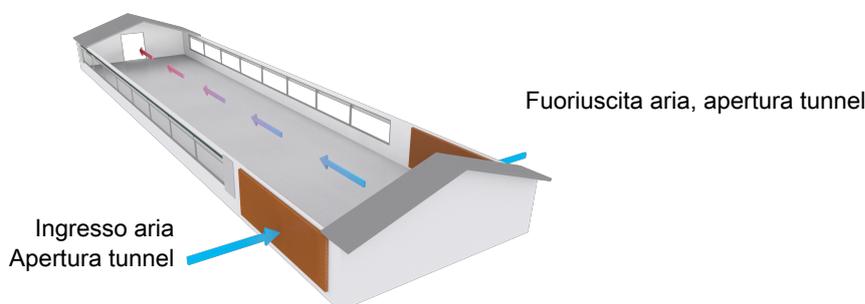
Esempio di capannone con ventilazione naturale unita alla ventilazione tunnel, Ventilazione tunnel
